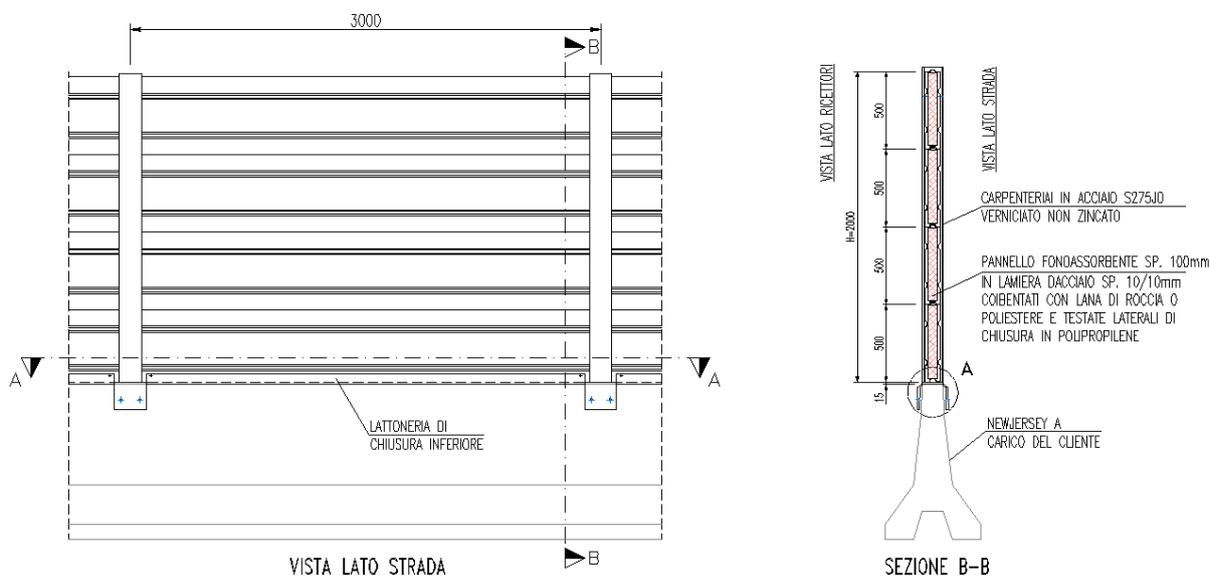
Tipologico barriera fonoassorbente da cantiere
